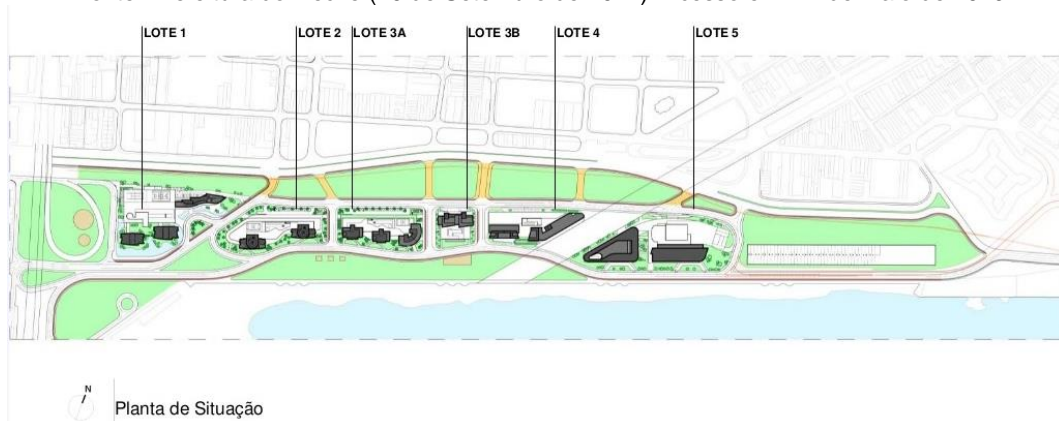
Planta Loteamento Projeto Mirante do Cais
